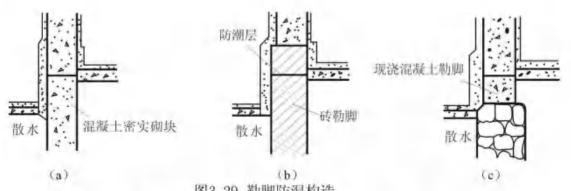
勒脚防湿构造 (a)密实混凝土砌块; (b)实心砖砌块; (c)现浇混凝土勒脚
